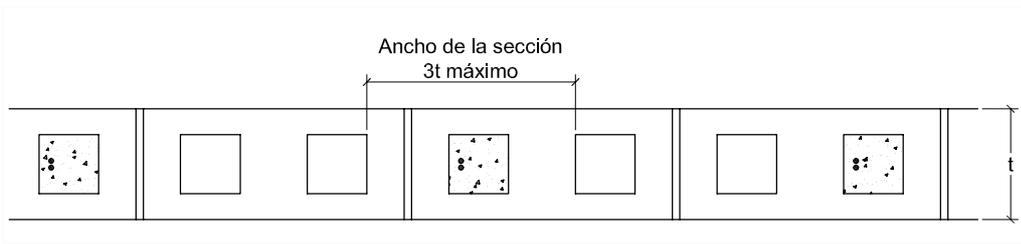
Ancho de las secciones con armaduras concentradas en huecos
